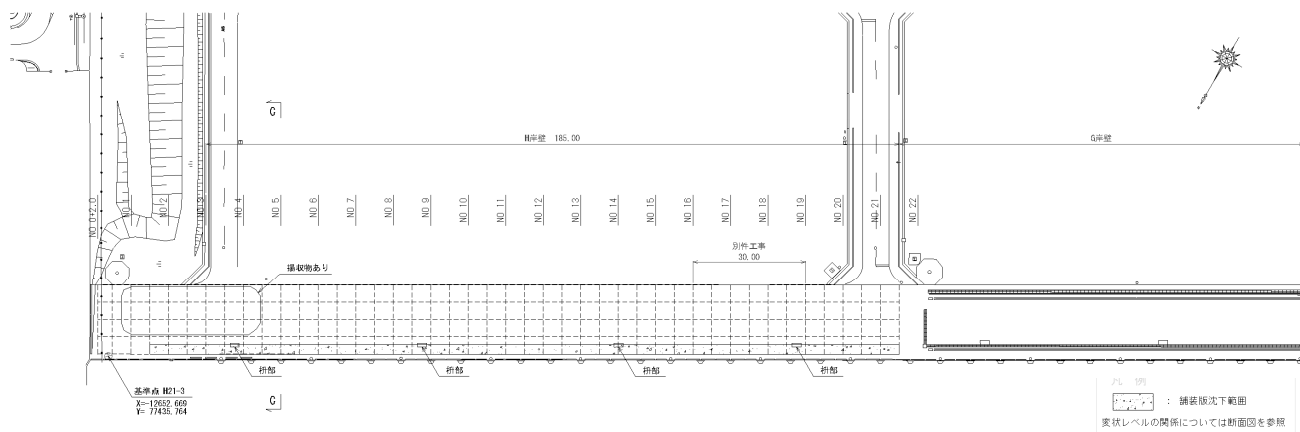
No.1 南公共ふ頭H岸壁(-10m) 平面図 (被災後)
